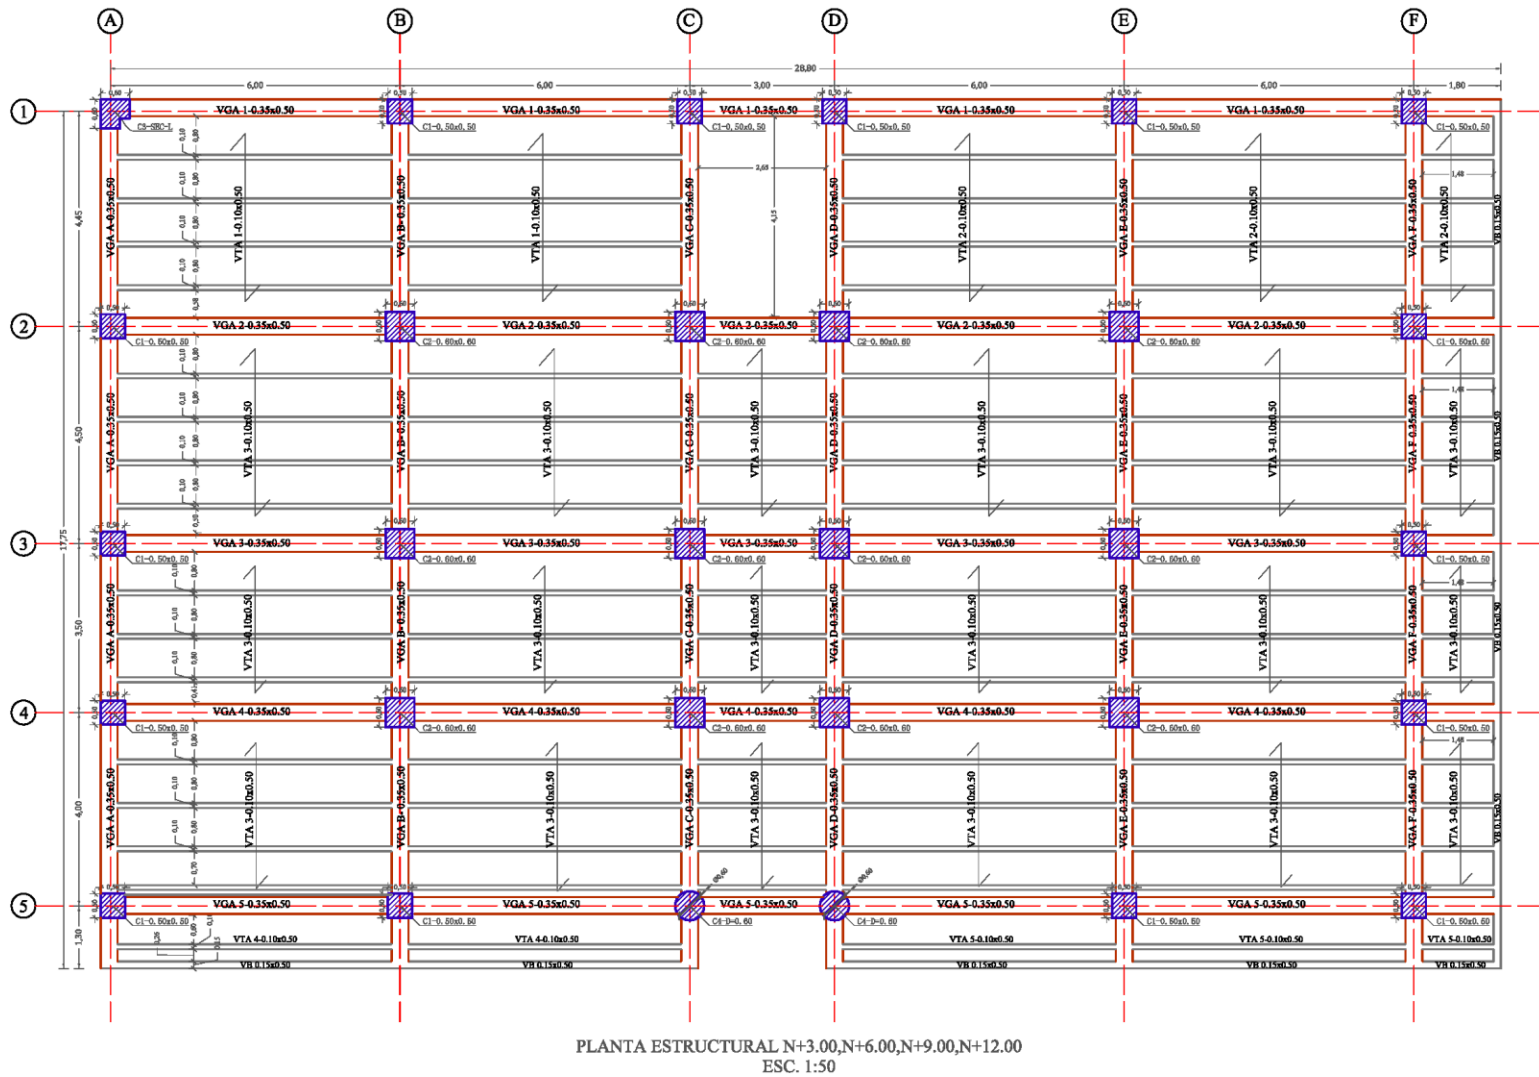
Planta estructural de losa de entrepiso (pisos 1-2-3-4).
